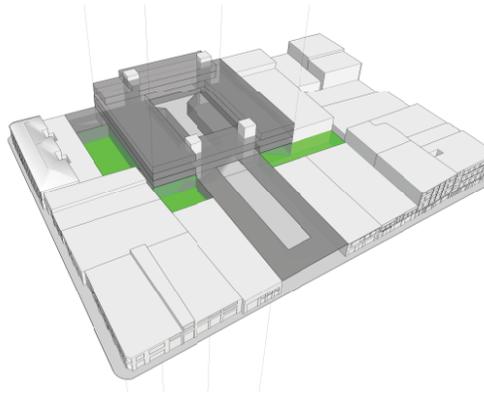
, Aislamientos propuestos, vista axonometría, realizado en sketchup, nov 2016, Elaboración propia
